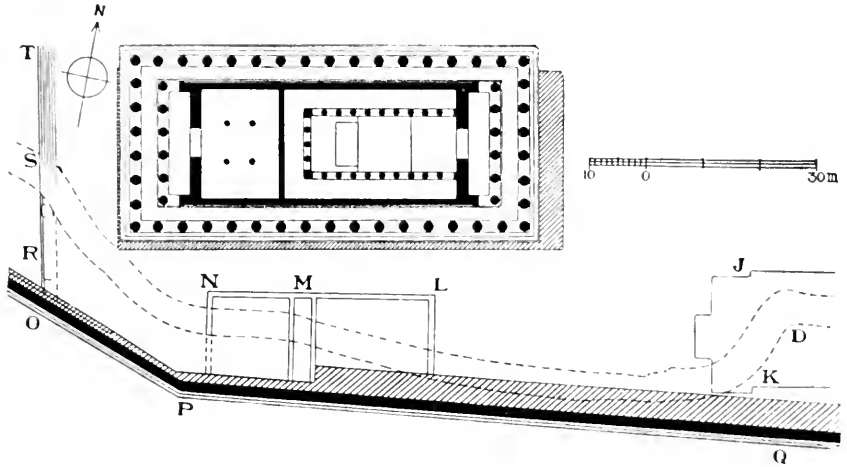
Grundriss des Parthenon und seiner südlichen Terrasse.
